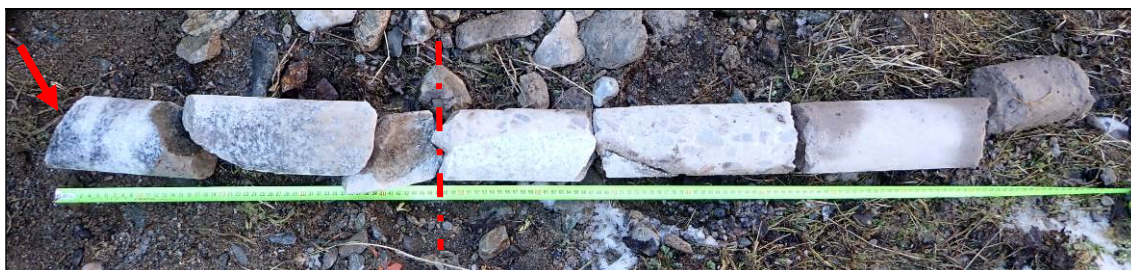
Pohled na výnos z vrtu Z2 pro stanovení hloubky založení opěry OP2. Šipkou vyznačen horní líc vrtu. Horní část vývrtu tvořena kamenným zdivem, přerušovanou čarou vyznačen začátek betonové části základu.
